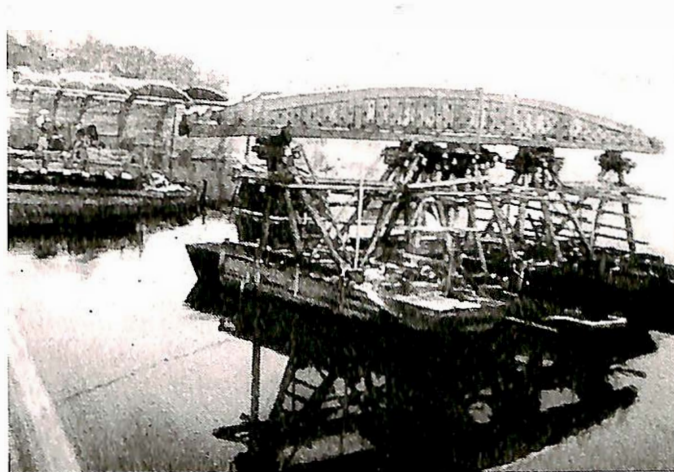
Betongbjelke blir førd ut på toppen av stillas på 4 pongtongar.
